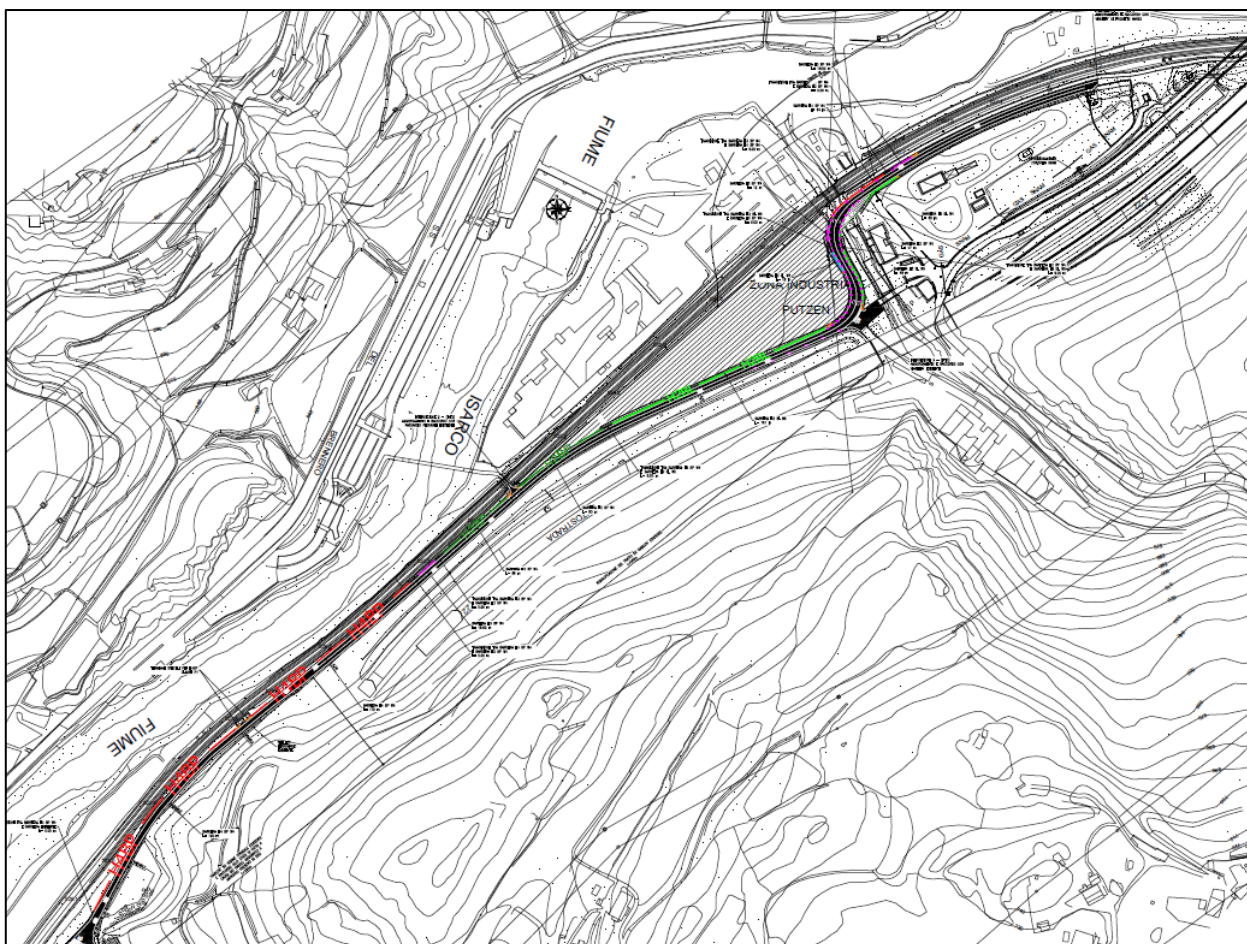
Stralcio planimetrico configurazione di progetto barriere di sicurezza NV042
